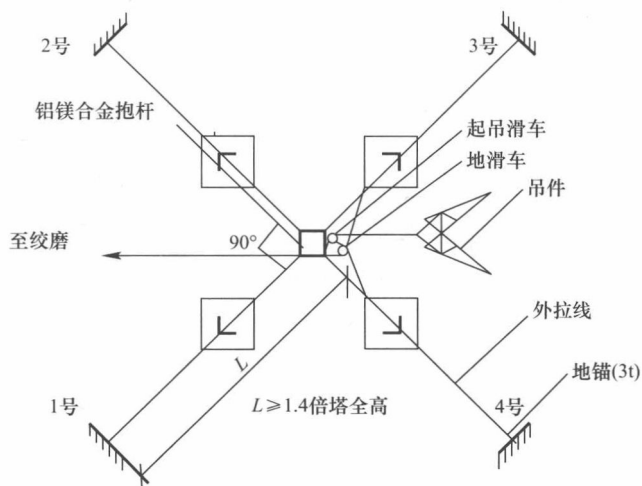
外拉线悬浮抱杆分解组塔平面布置示意图
